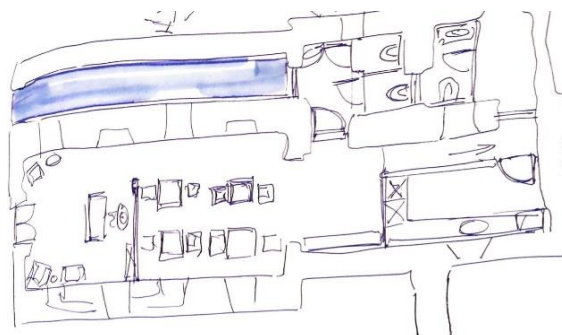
Planta de estudo; *Fonte: Mariana Vieira.
